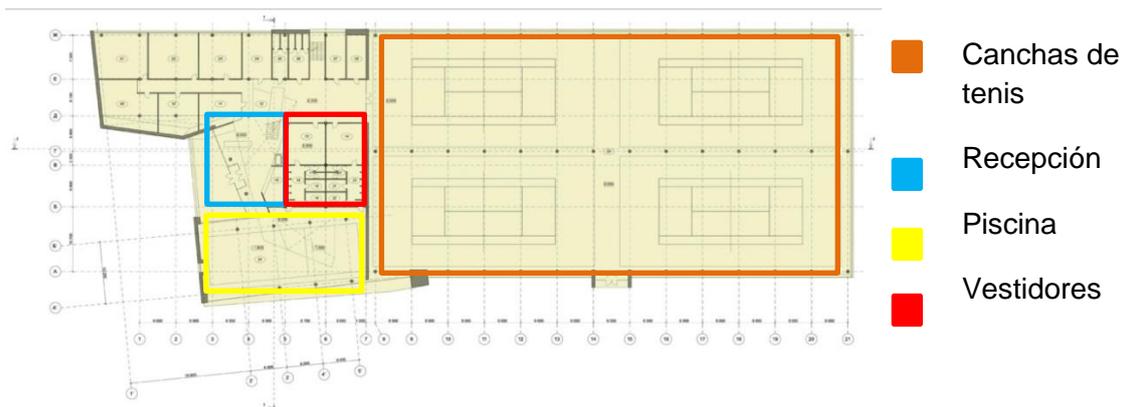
Planta Club de tenis Istra. Tomado de (Za Bor Architects, 2014)
